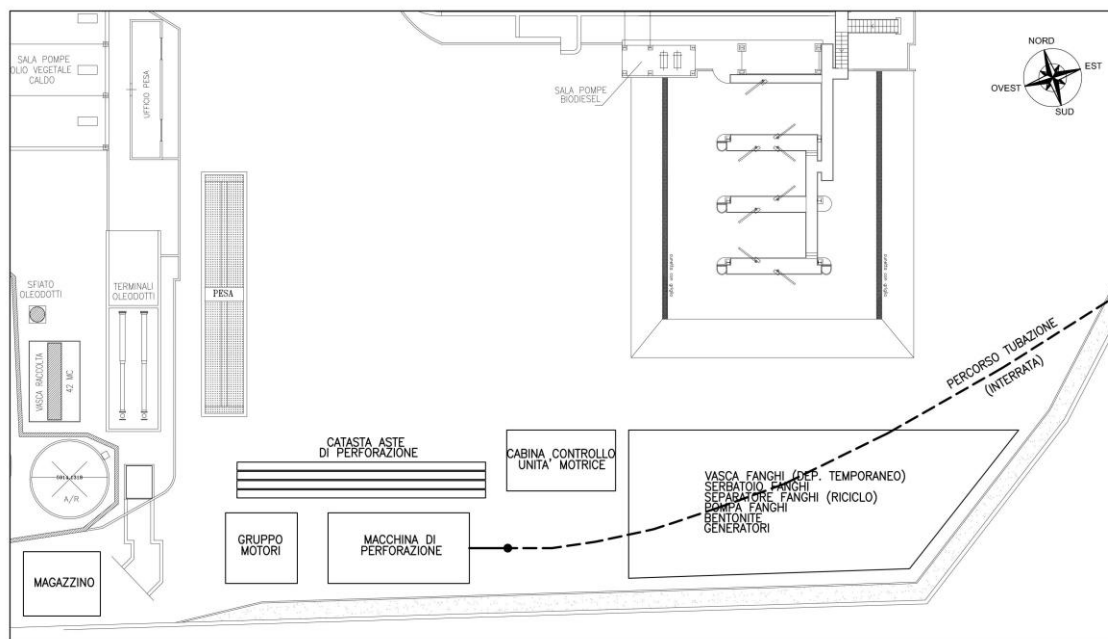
Individuazione area cantiere TOC nello stabilimento Ecofox di Vasto. Area B.
